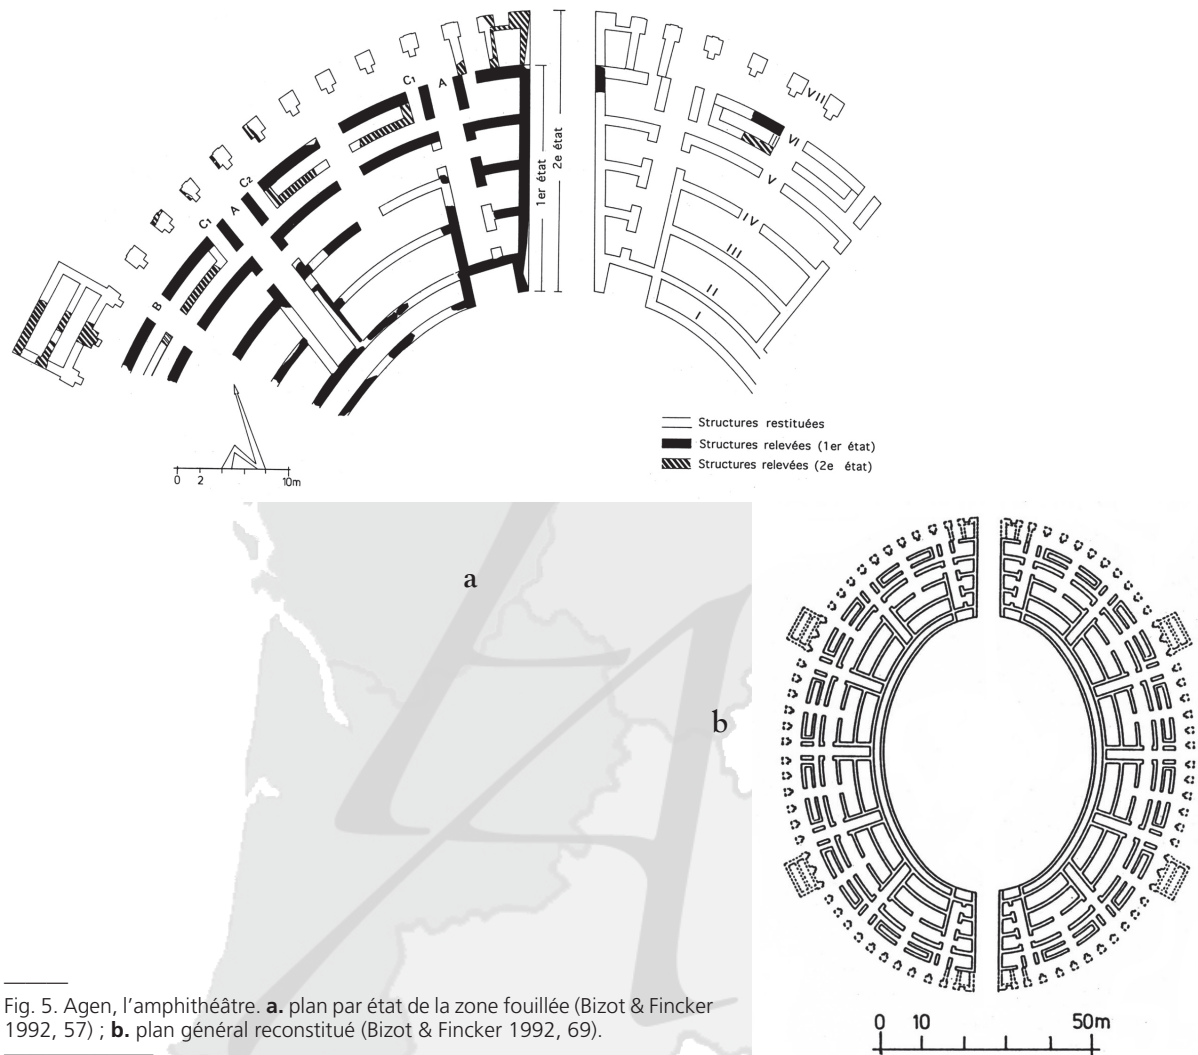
Agen, l'amphithéâtre. a. plan par état de la zone fouillée (Bizot & Fincker 1992, 57) ; b. plan général reconstitué (Bizot & Fincker 1992, 69).
